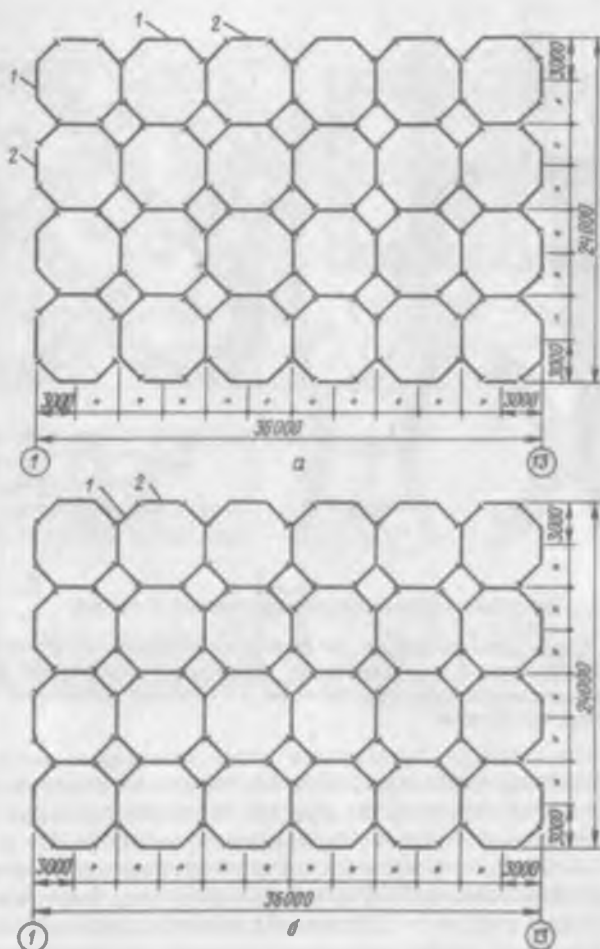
Монтажные схемы стен корпусов с силосами из трехгранных и плоских элементов:
